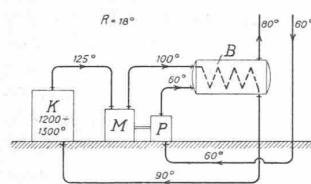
Dampf-Warmwasserheizung unter Verwendung des Dampfes zum Pumpenantrieb.
